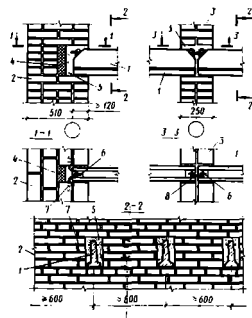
Детали опирания сборных железобетонных балок чатеребристых перекрытий на каменные стены:
